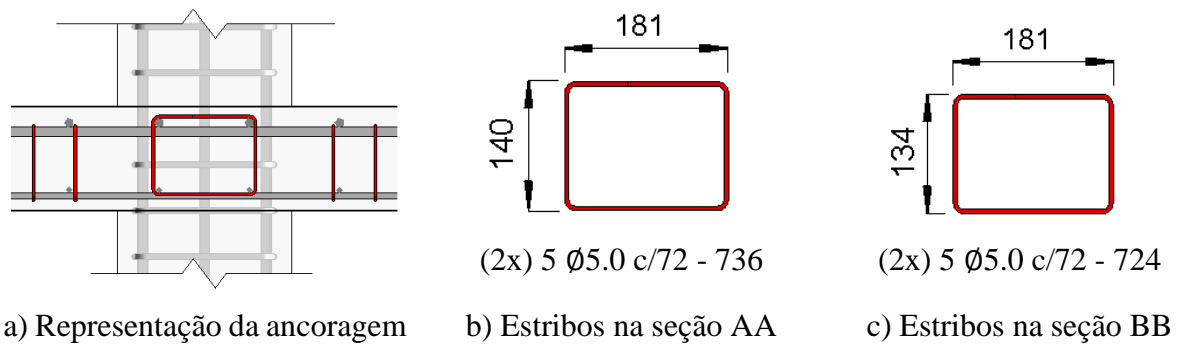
Detalhamento dos estribos da laje FA-05 (unidades em mm)
